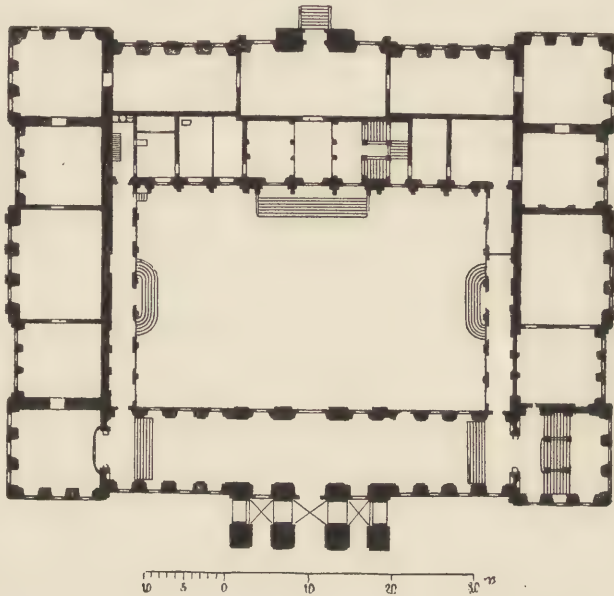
Japanisches Palais zu Dresden. Grundriss des Erdgeschosses.
